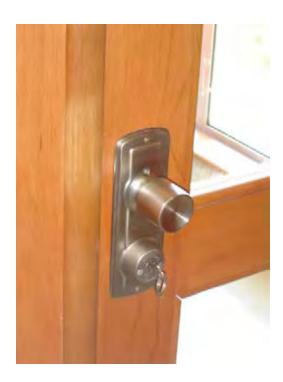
Puertas de escape con la llave puesta en la chapa
